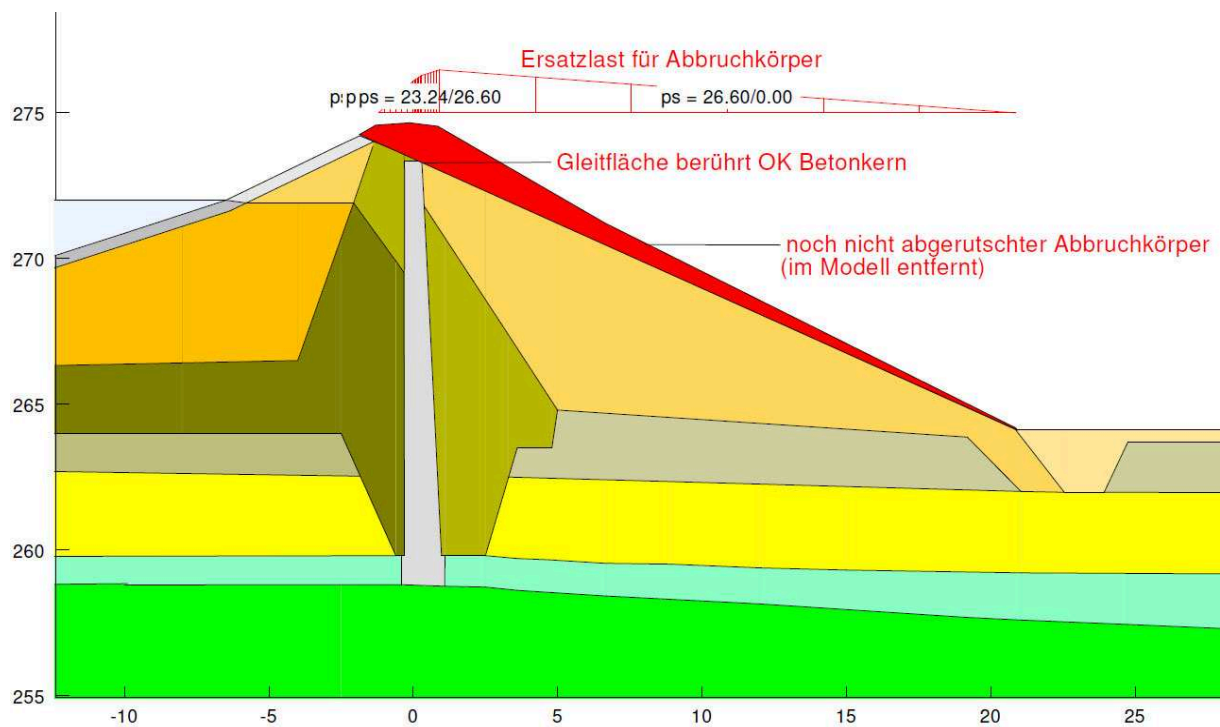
TS Auma, Lastfall Bemessungserdbeben, Restkörper mit Auflast in der Belastungssituation 2
